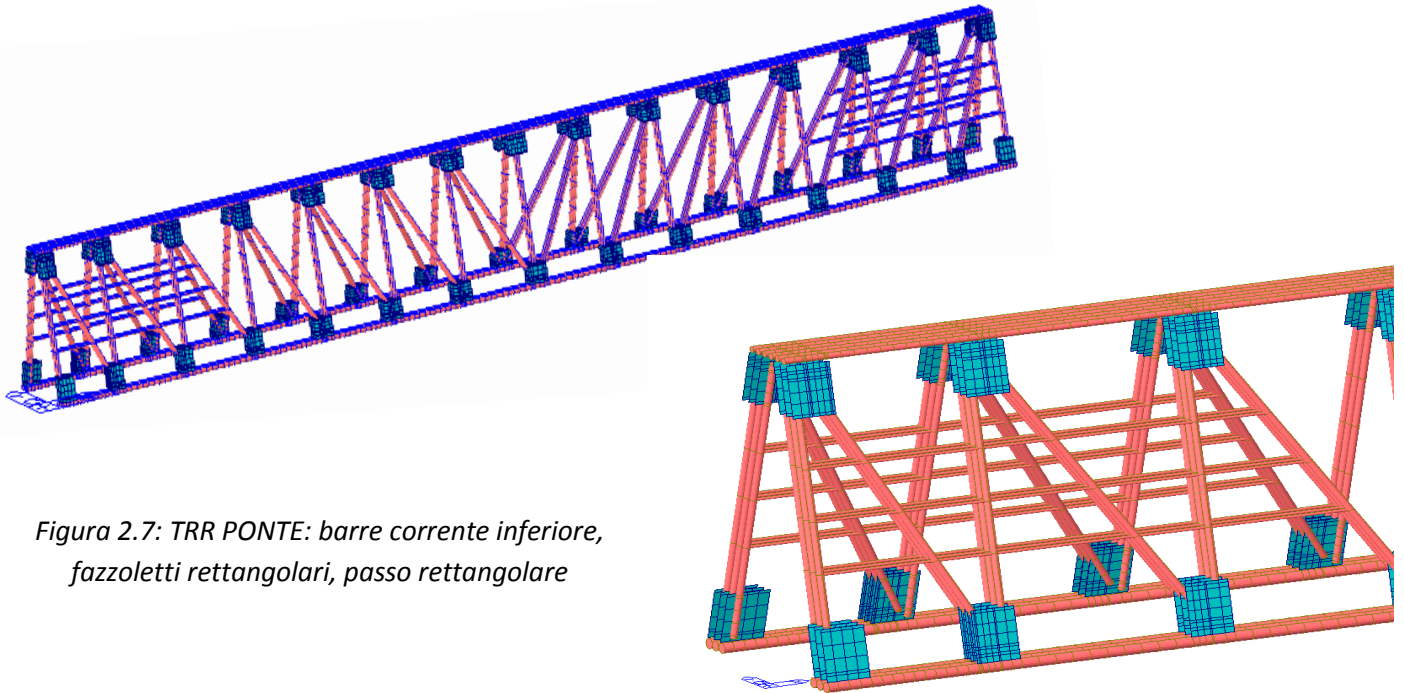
TRR PONTE: barre corrente inferiore, fazzoletti rettangolari, passo rettangolare
